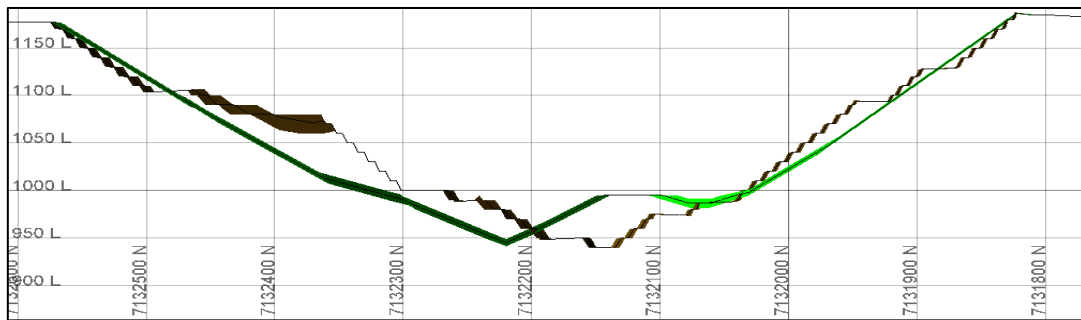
LGMM2Y Fase 3 - Vista en sección - Corte principal N-S E394350
